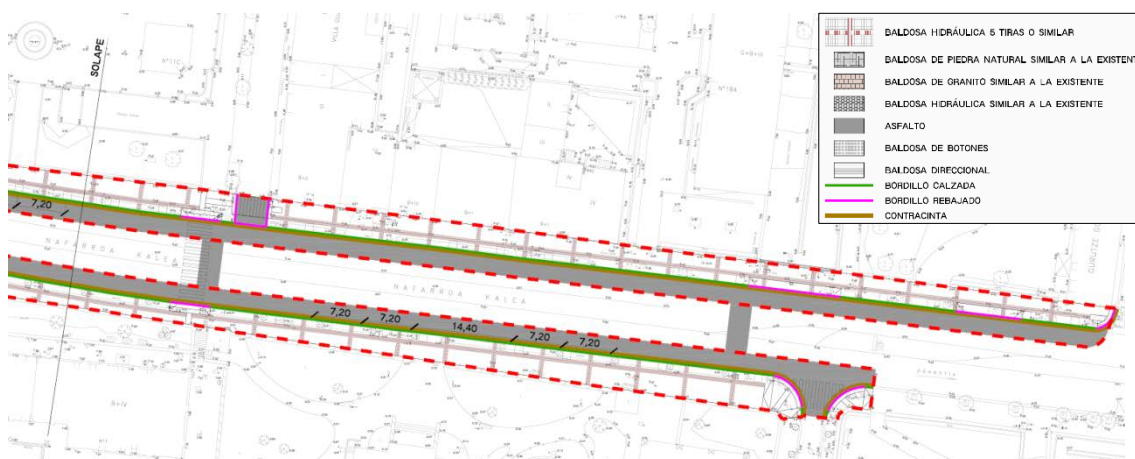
Plano de pavimentación de la zona oeste de Nafarroa kalea. 2/2
